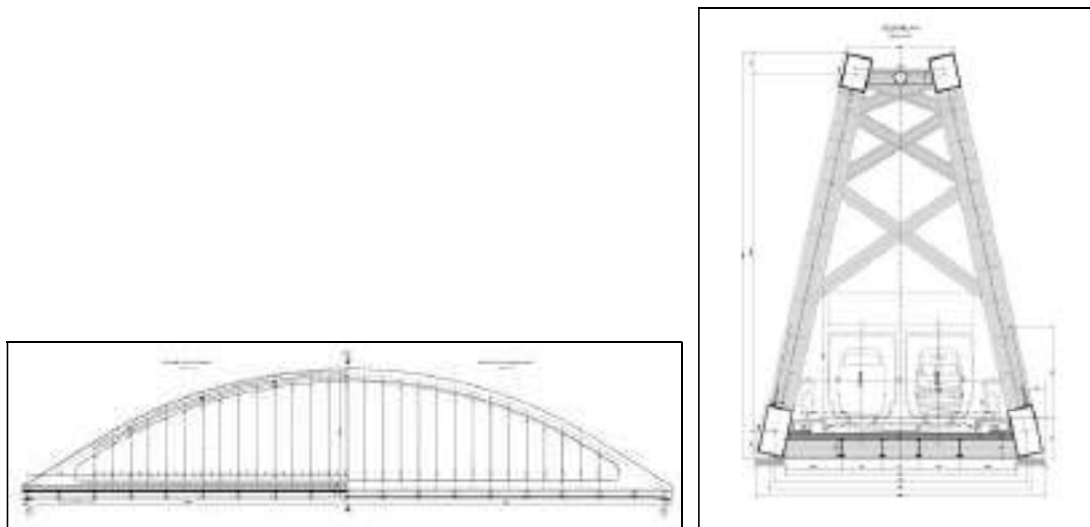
Profilo e sezione del ponte sulla Dora Riparia – Opzione struttura ad arco superiore
